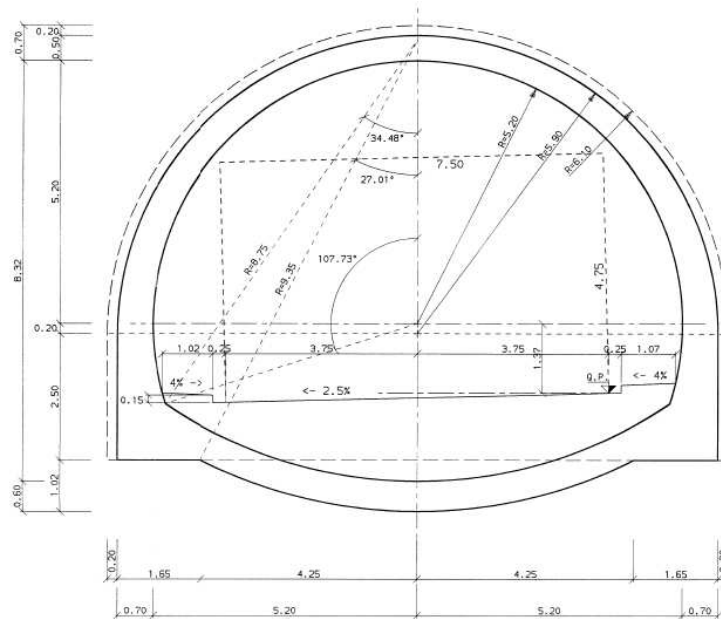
PE GEODATA 1996 – Galleria Guinza - Sezioni Tipo C2 – Carpenteria
